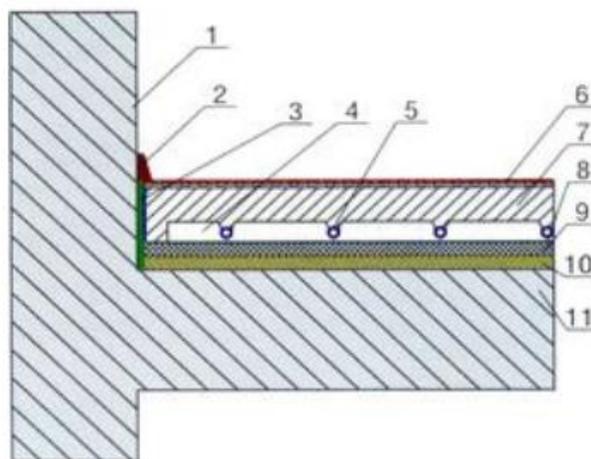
Конструкция пола с водяной системой отопления: 1 – стена, 2 – плинтус, 3 – демпферная плита, 4 – шина для укладки труб, 5 – металлопластиковая или полимерная труба, 6 – напольное покрытие, 7 – бетонная стяжка, 8 – гидроизоляция, 9 – тепловая изоляции, 10 – слой звукоизоляции, 11 – плита перекрытия
